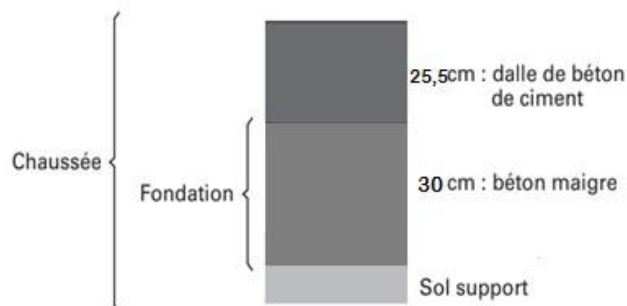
Épaisseur des couches de chaussée rigides pour une zone de Piste et bretelles.
